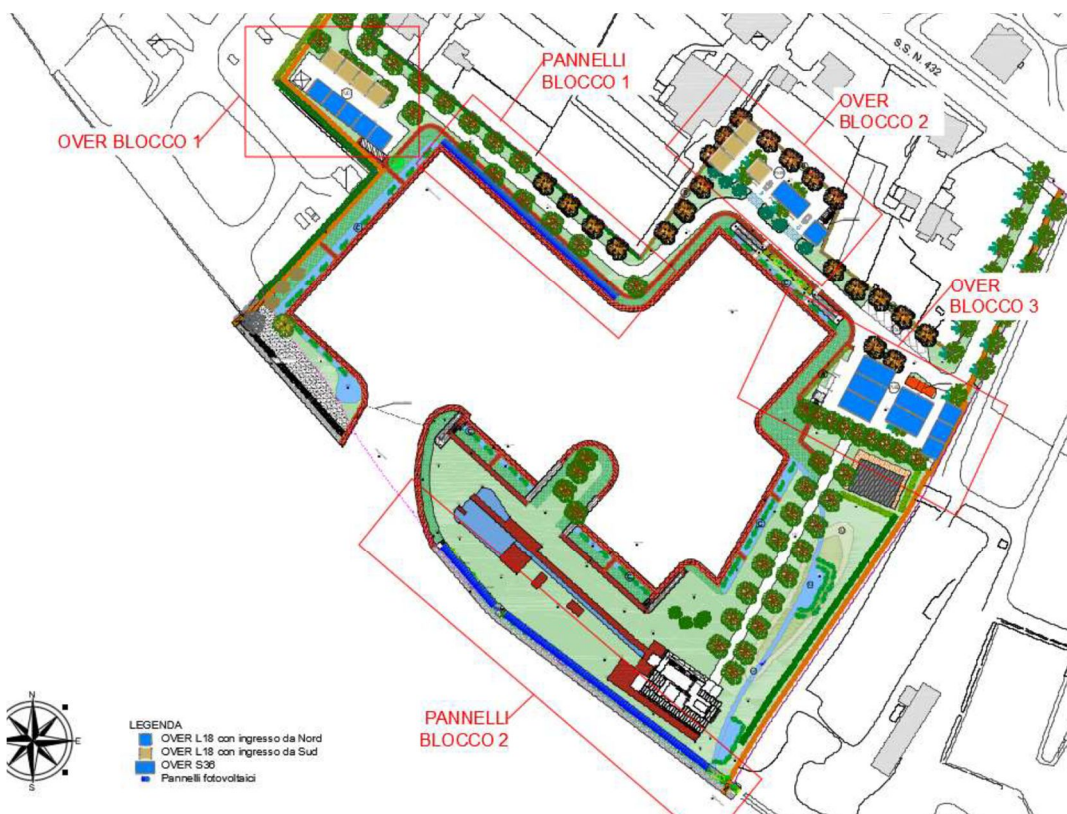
Planimetria complessiva impianti fotovoltaici di progetto (in colore blu)
